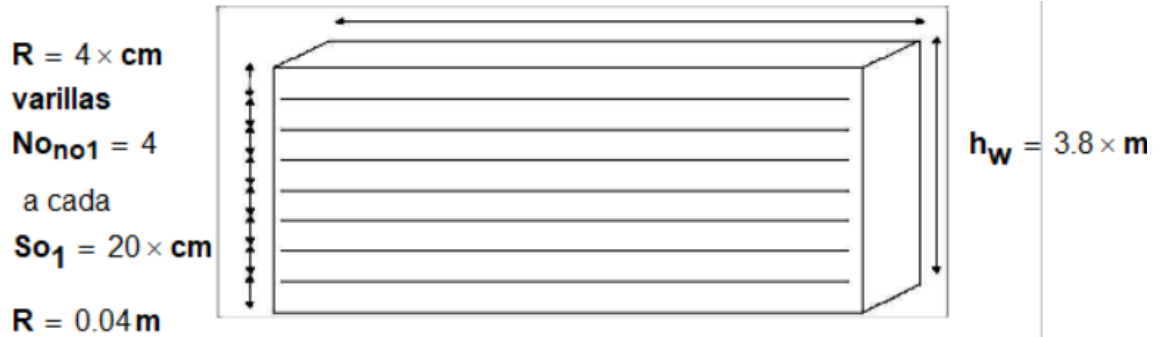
Detalle de refuerzo longitudinal muro 1 y 2, ejemplar dos
